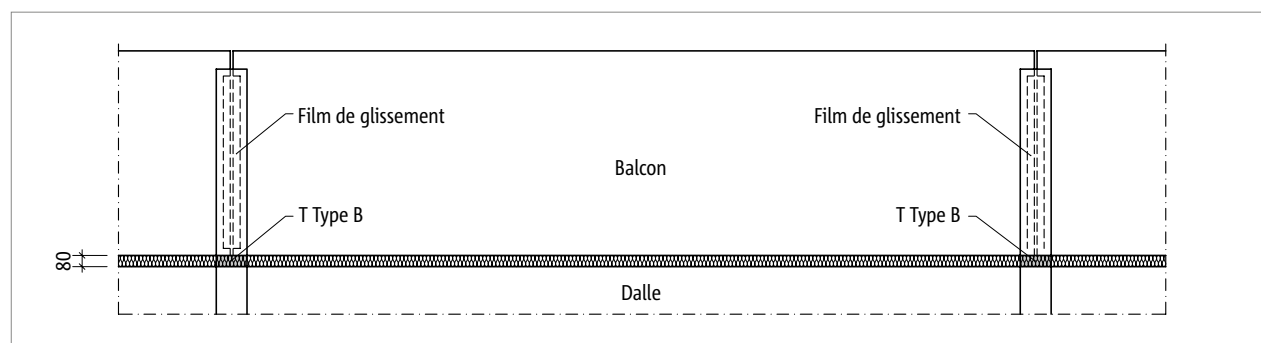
Schöck Isokorb® T Type B : Plan de base ; Résistance à la fatigue grâce au film de glissement entre les dalles de balcon et les poutres en porte-à-faux
